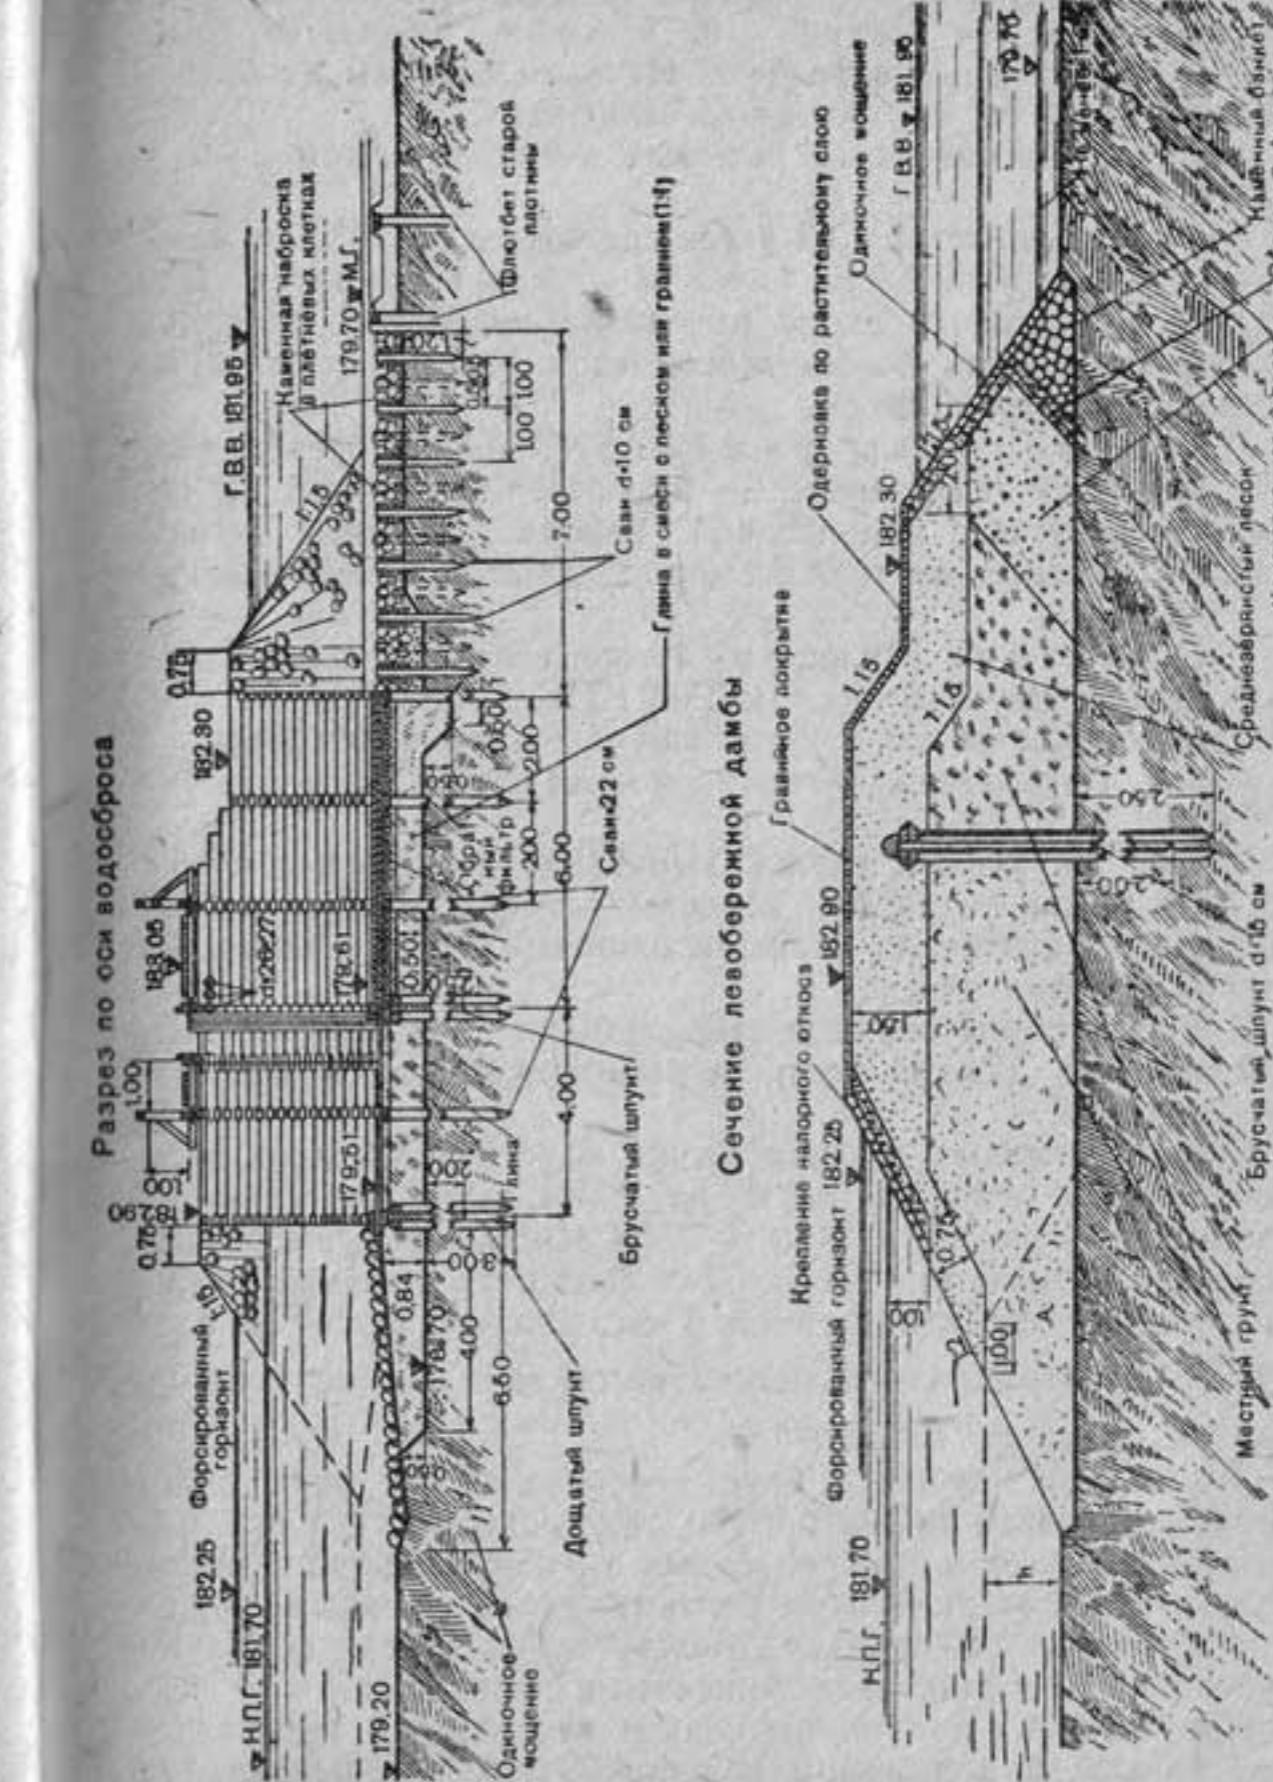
Плотина № 1 (разрез по оси водосброса и сечение левобережной дамбы); А — перемычка, отсыпавшаяся из любых местных грунтов в воду.
